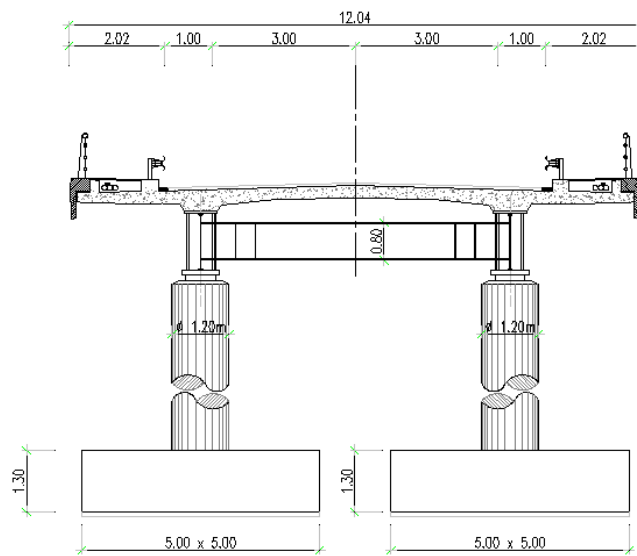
Pont mixte acier-béton avec des culées intégrales - famille d'ouvrage de petite portée (B3).
